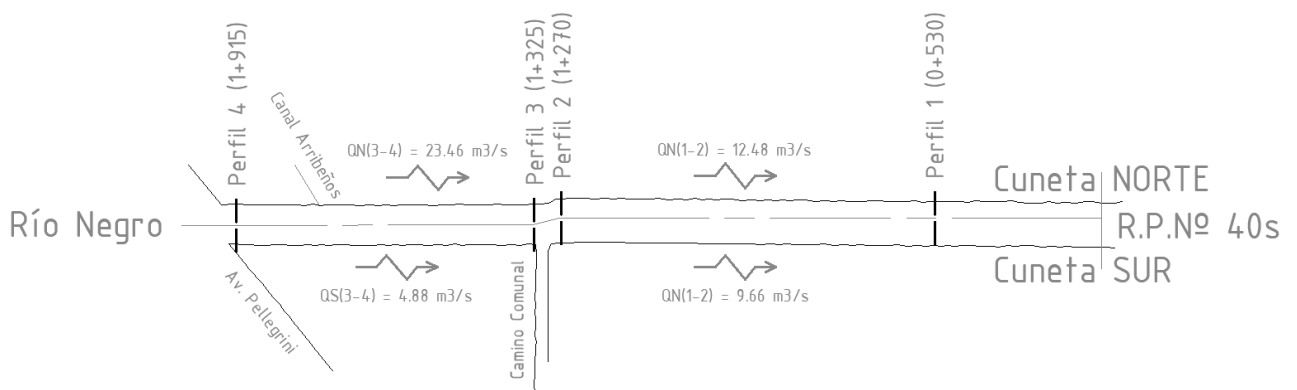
Esquema resumen de capacidad hidráulica de Río Negro.
